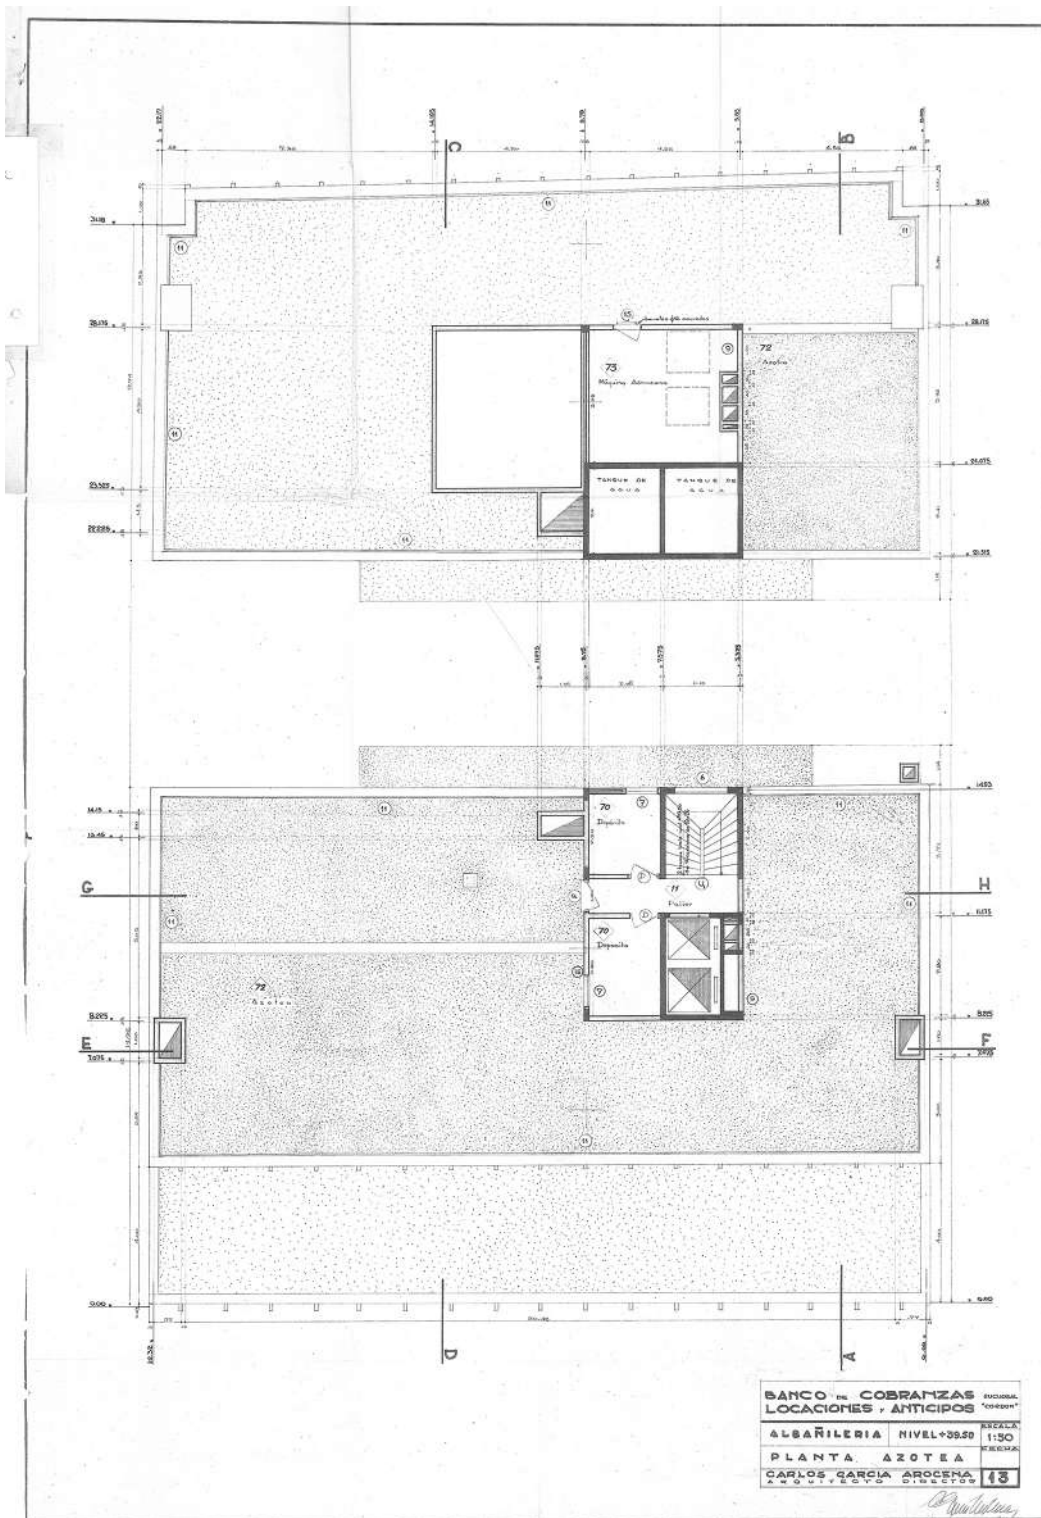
Lámina 13 del proyecto ejecutivo del BCLA: planta de azoteas.
